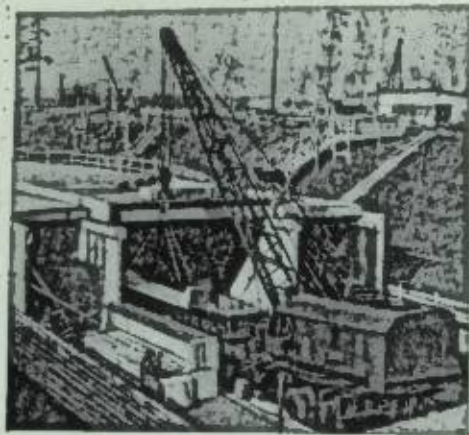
Монтаж железобетонных туннельных конструкций в открытом котловане.
